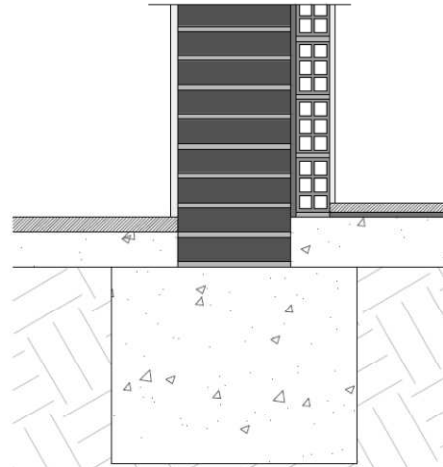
Fachada-Solera. Zona oeste. Estado original.
